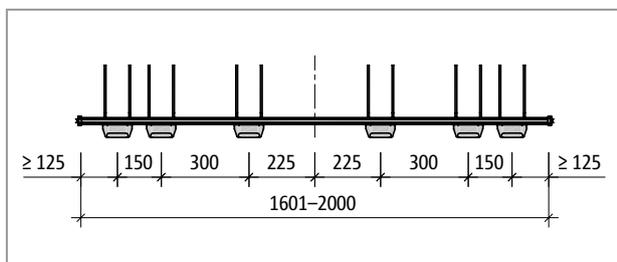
Schöck Tronsole® Typ T-V6-...-L1601 bis L2000: Produktgrundriss
